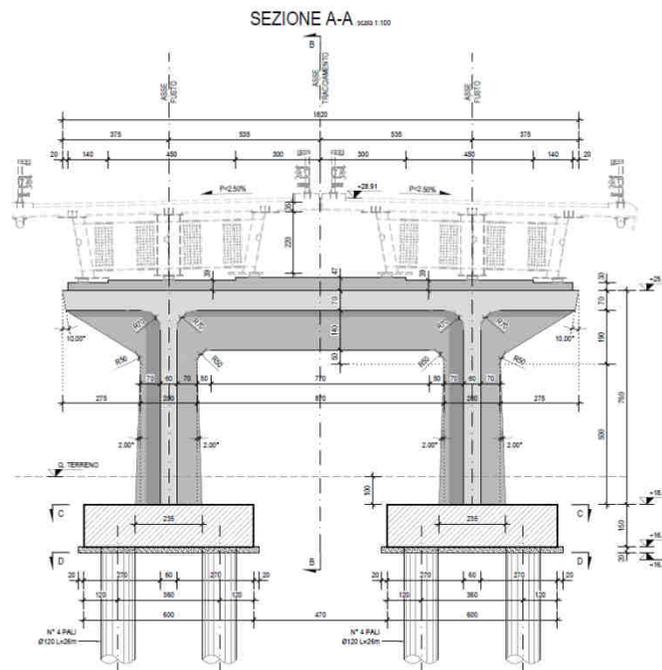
Prospetto pila 6 "speciale", tra campate da 48m - Viadotto Selargius Centro
